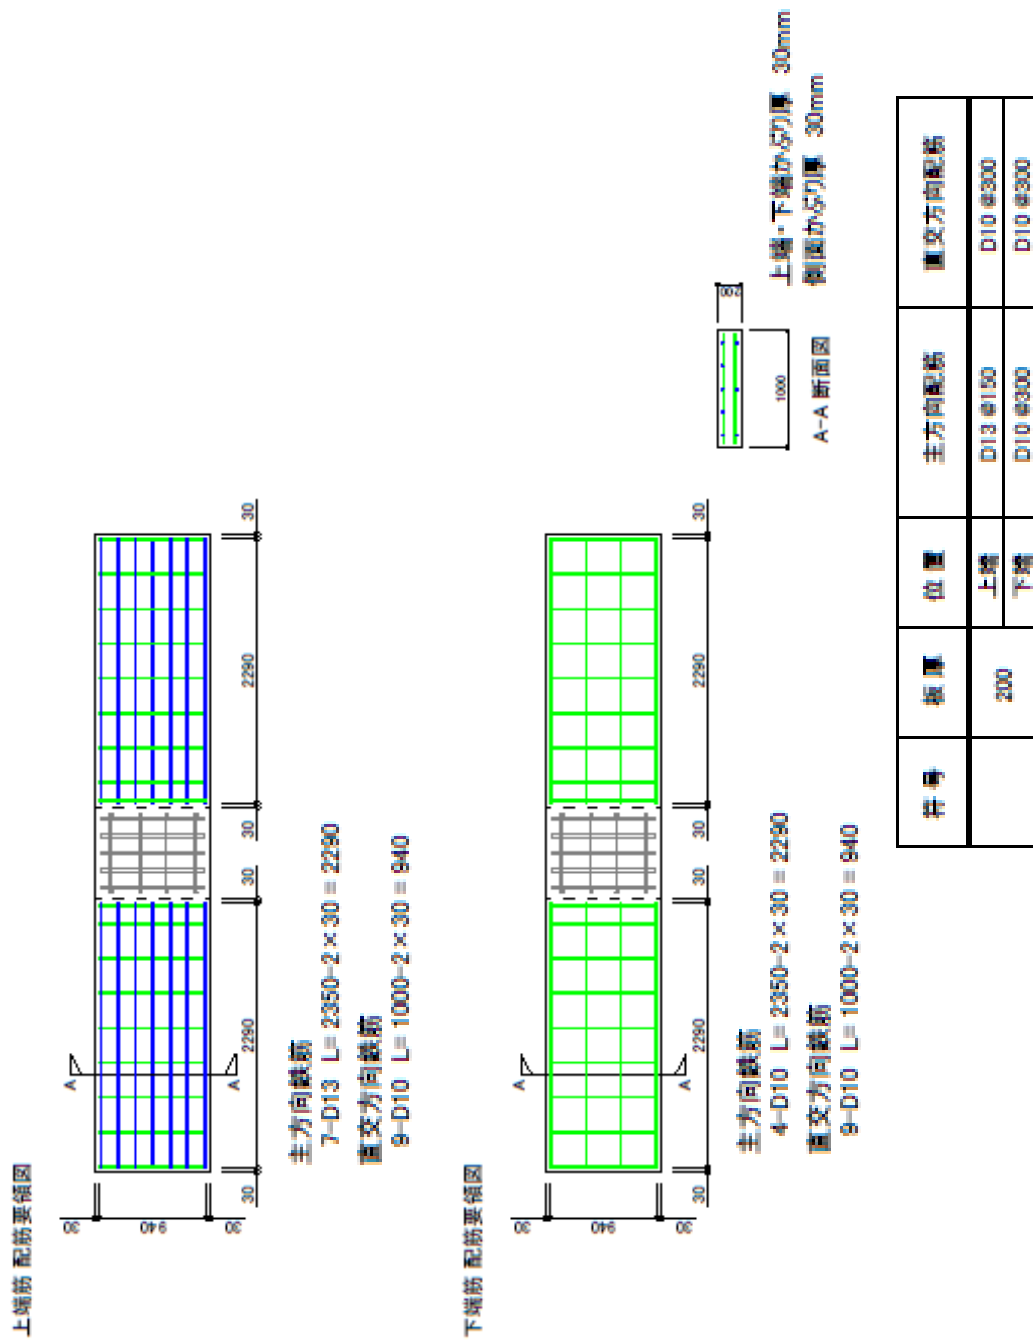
スラブ配筋図(CA, CB 試験体)
